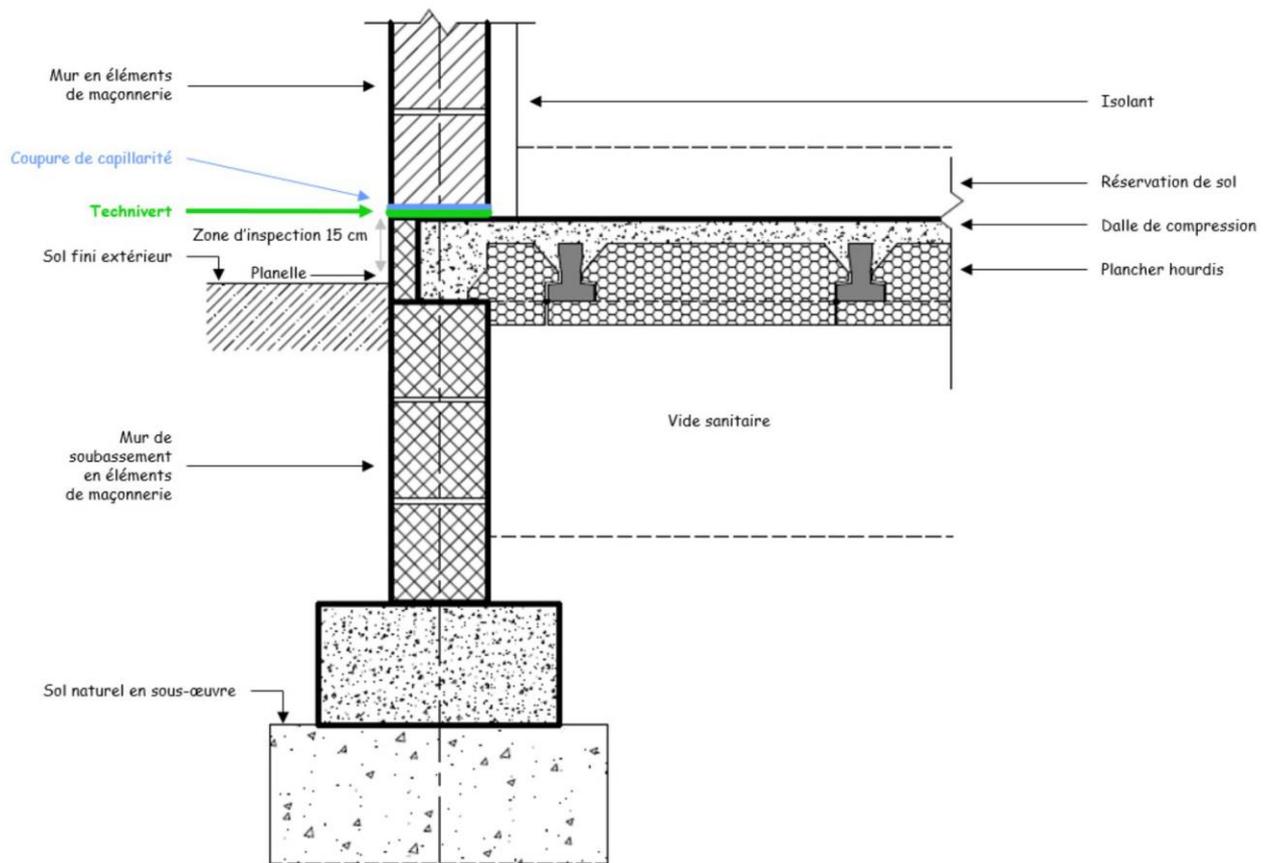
Plancher à poutrelles en béton - Elévations maçonneries
